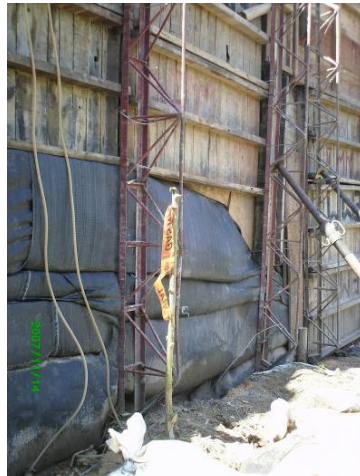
Deformaciones en el geotextil y fallas en el pendiente
